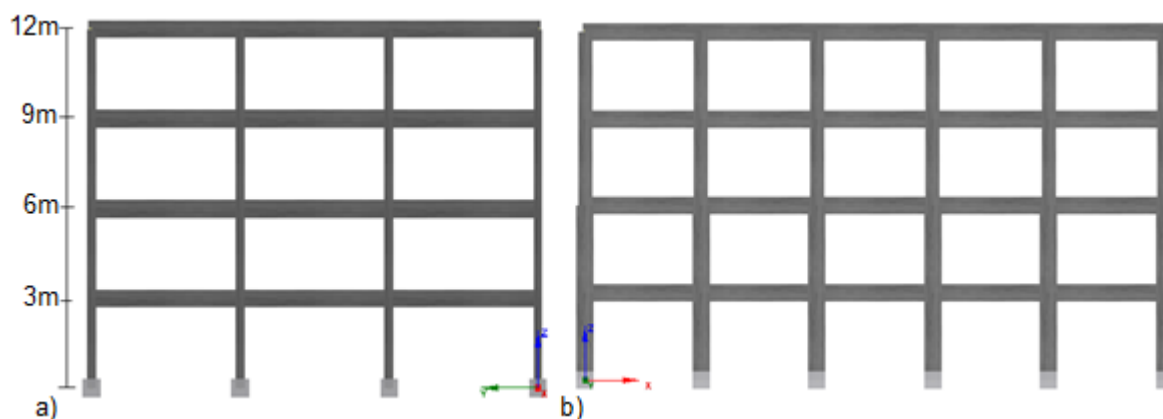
Edifício PT4 – a) Pórtico Longitudinal b) Pórtico transversal
